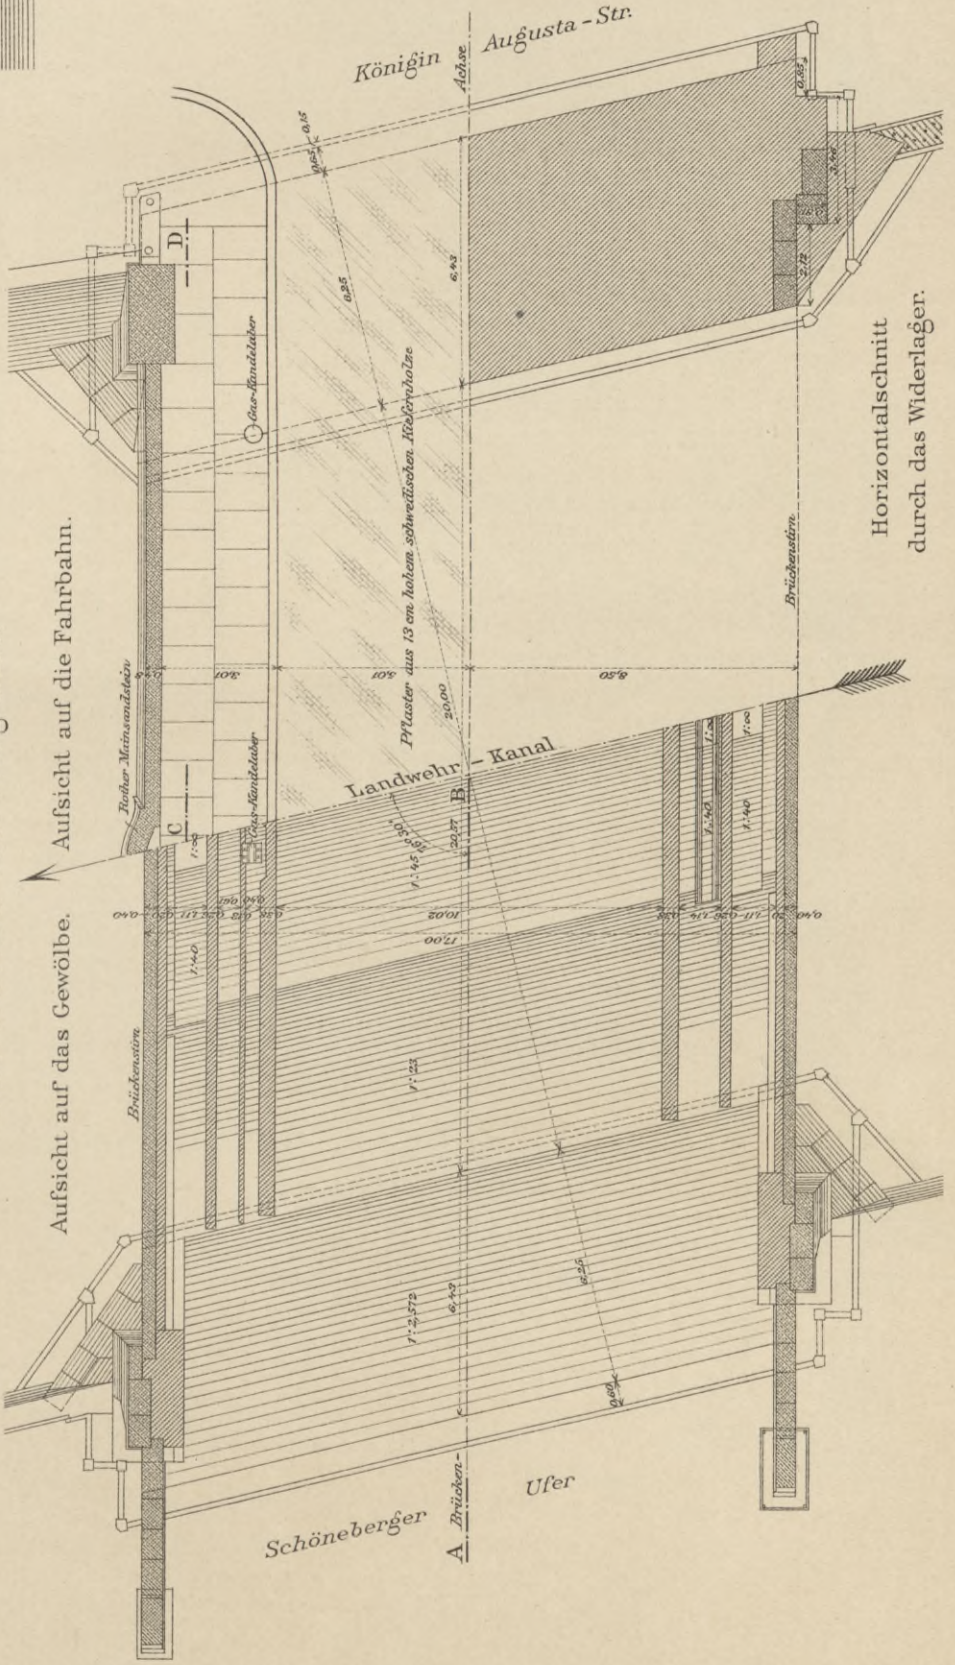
Grundriss-Anordnung. 1:200.
